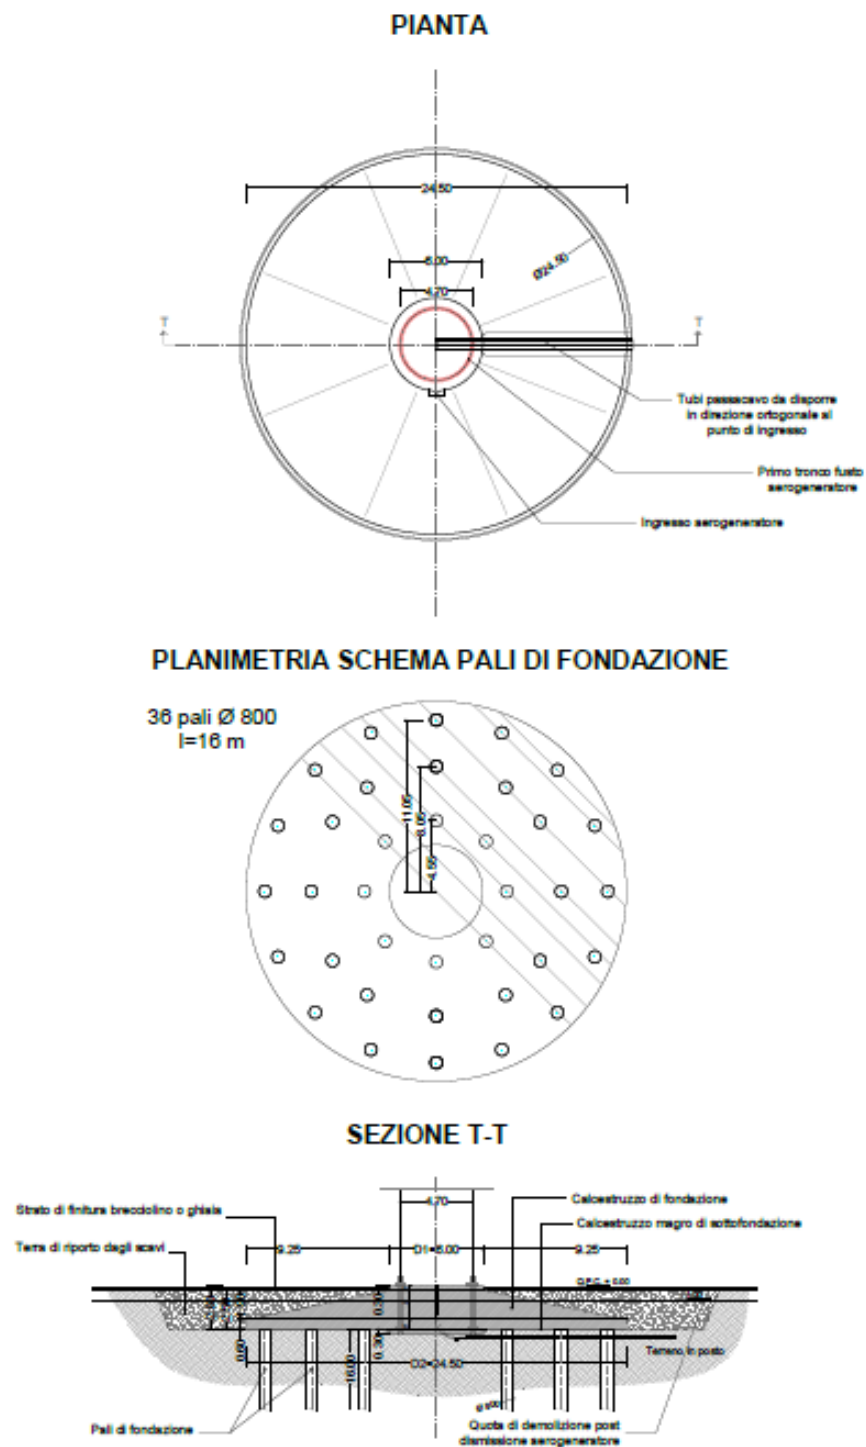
Pianta e vista della fondazione tipo dell'aerogeneratore (su pali).
